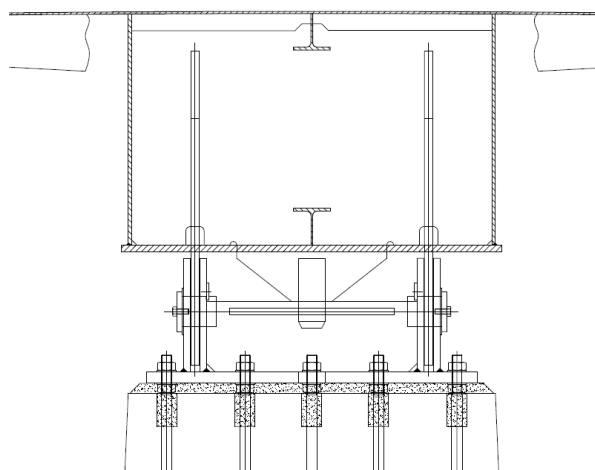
Secção transversal do tabuleiro concebido com viga caixão, na zona dos pilares [24].
